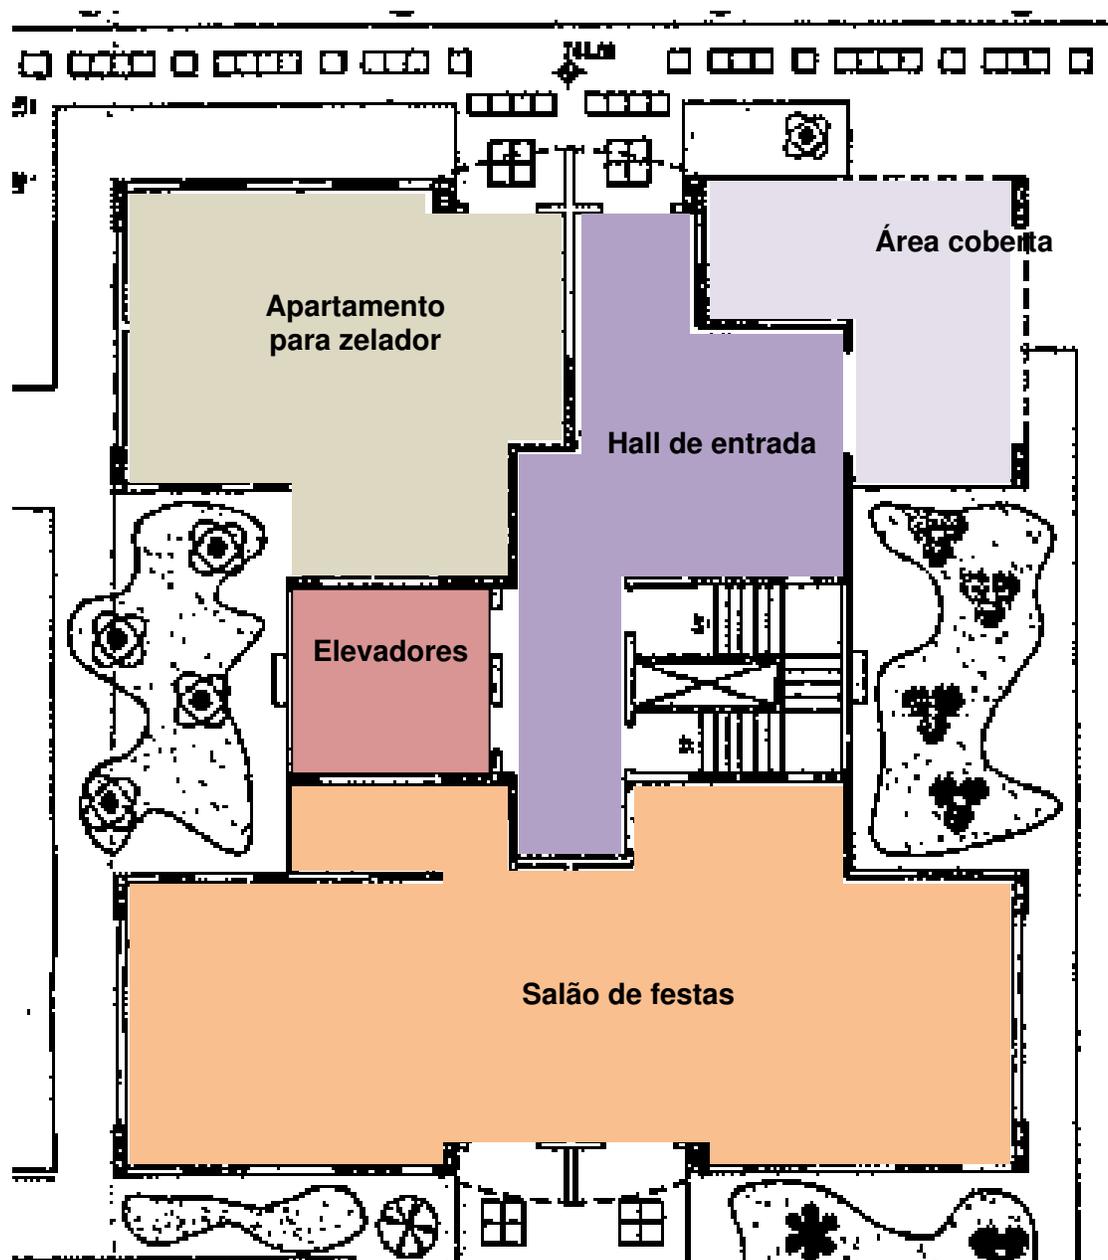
Edifício Cotê d'azur. Fonte: a partir da planta original de implantação e paisagismo.
